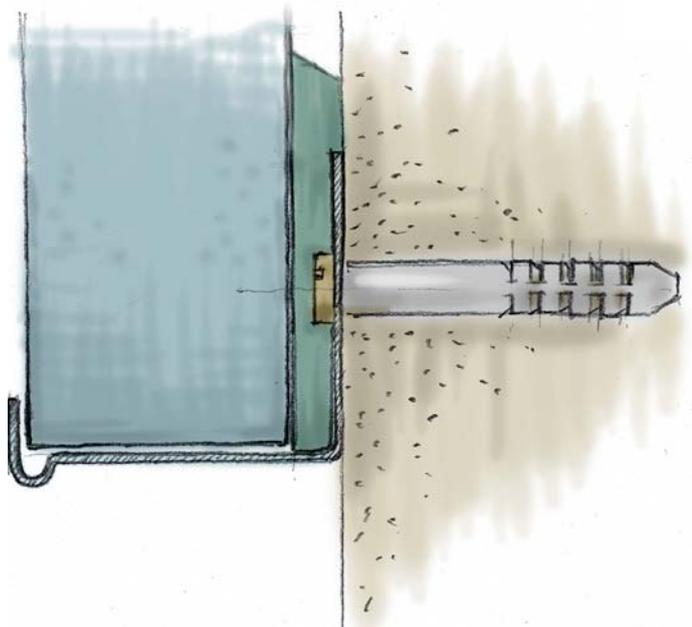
Sezione corretta del montaggio del profilo di partenza: leggero spessore di compensazione dietro il pannello
